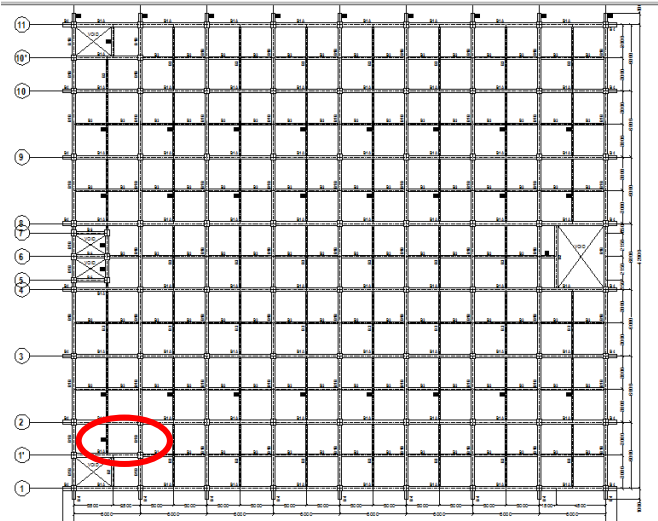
Detail Tulangan Balok B1A pada Lantai 2
